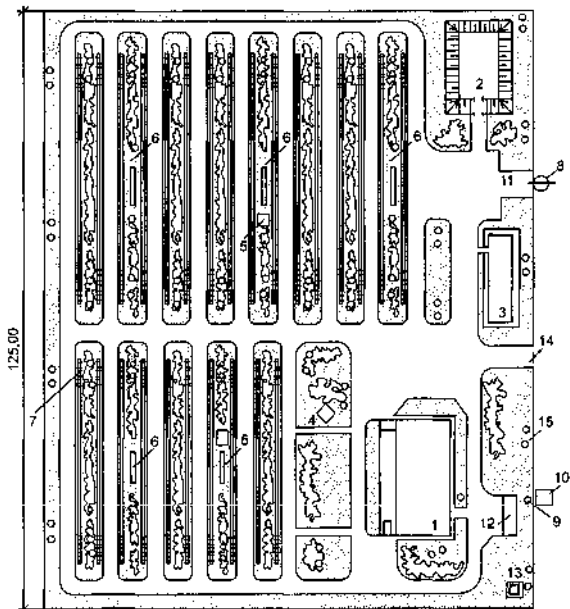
Схема генерального плана пчеловодческой фермы на 600 пчелиных семей (ТП 808-05-18.86):
